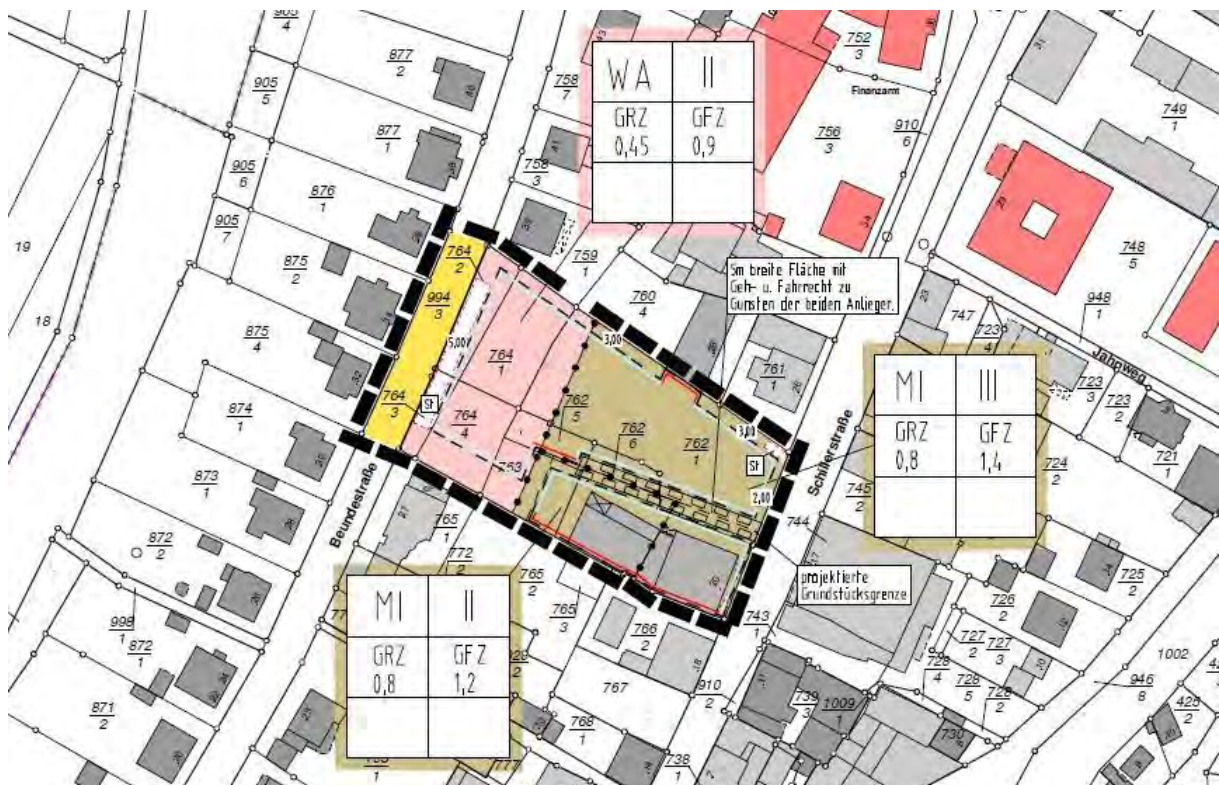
Bebauungsplan N 32 „Schillerstraße 20 - 24“
